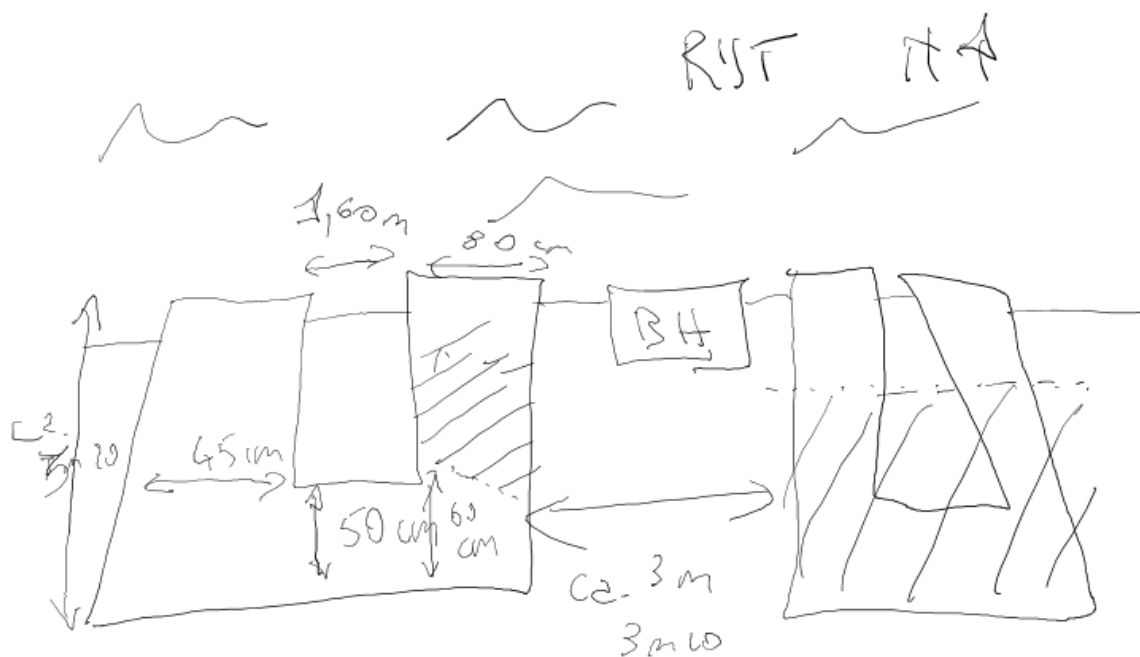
Terreinschets bakstenen constructie met afmetingen. Legende: bh staat voor blauwe hardsteen, de arceringen duiden de vermoedelijke ligging aan (wegens afdekking met aarde).
